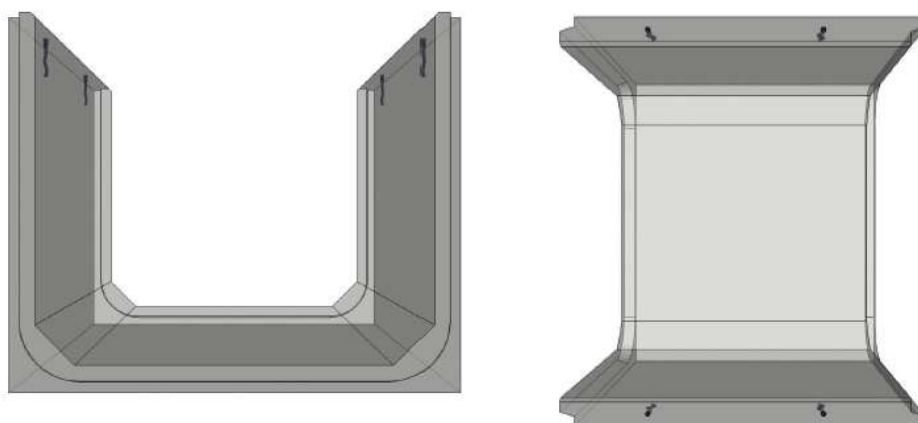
SCATOLARE AD U IN PROGETTO
